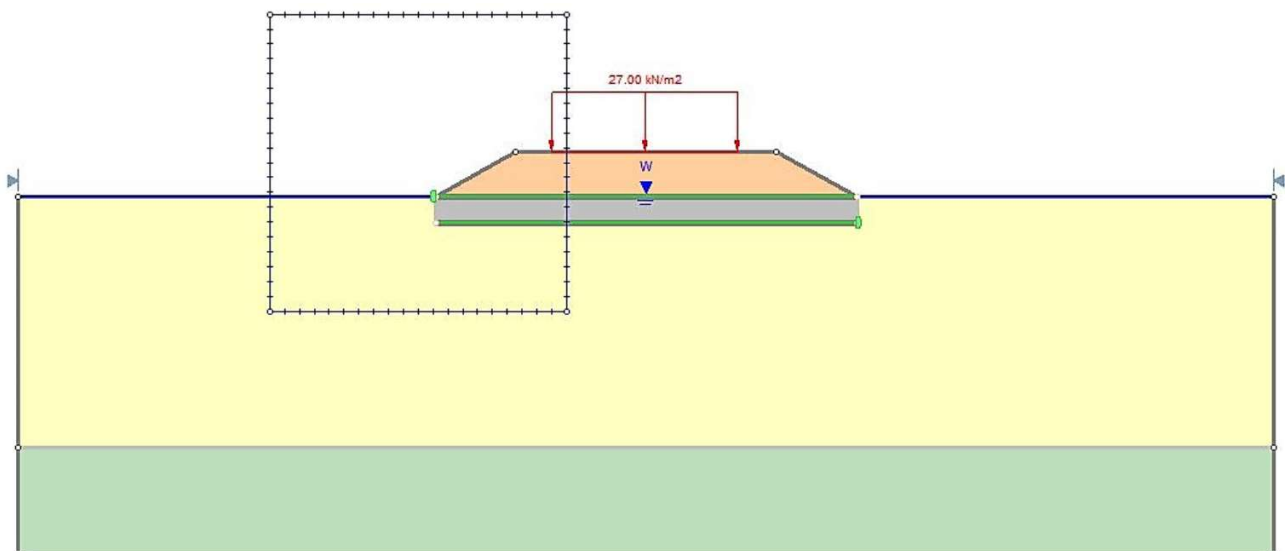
RILEVATO IN ZONA ARMELLINA H = 2,50 M – SCHEMA DI CALCOLO
